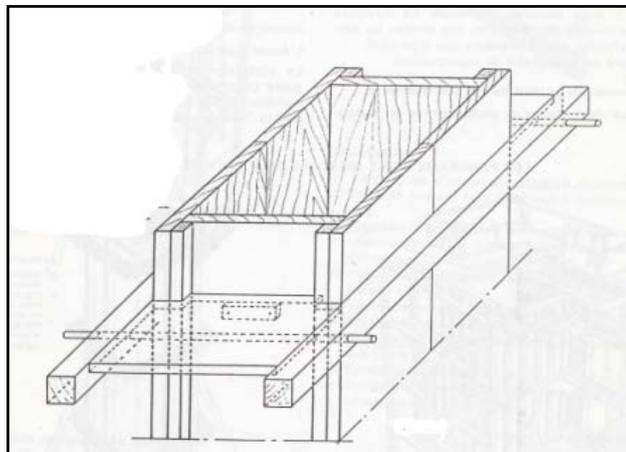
Coffrage en bois pour un poteau de moyenne section
